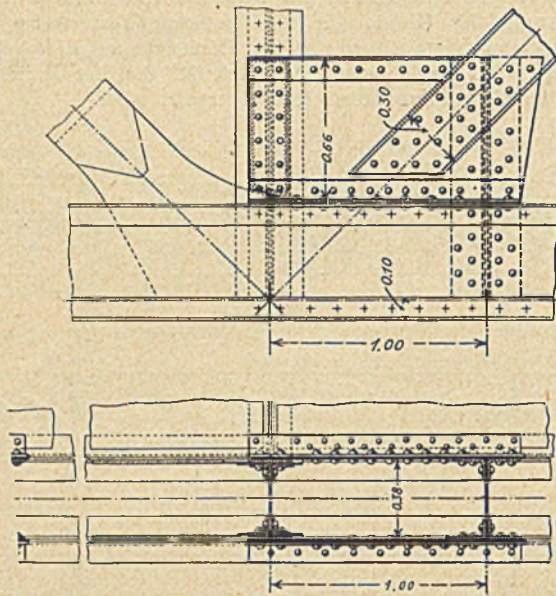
Unterer Anschluß einer der neuen Gegenstreben.
